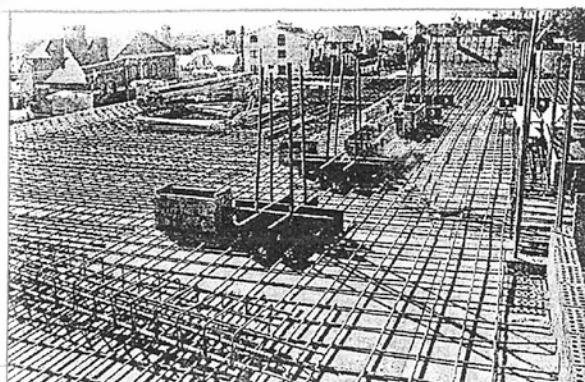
Распределительная система с жесткой арматурой в виде крестовины без дополнительного поперечного армирования
